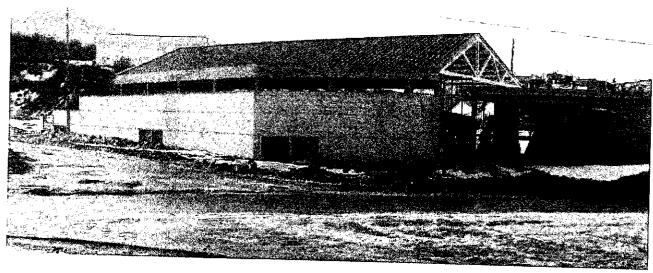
Construcción existente 2015 (Lavadero de Automovil)
